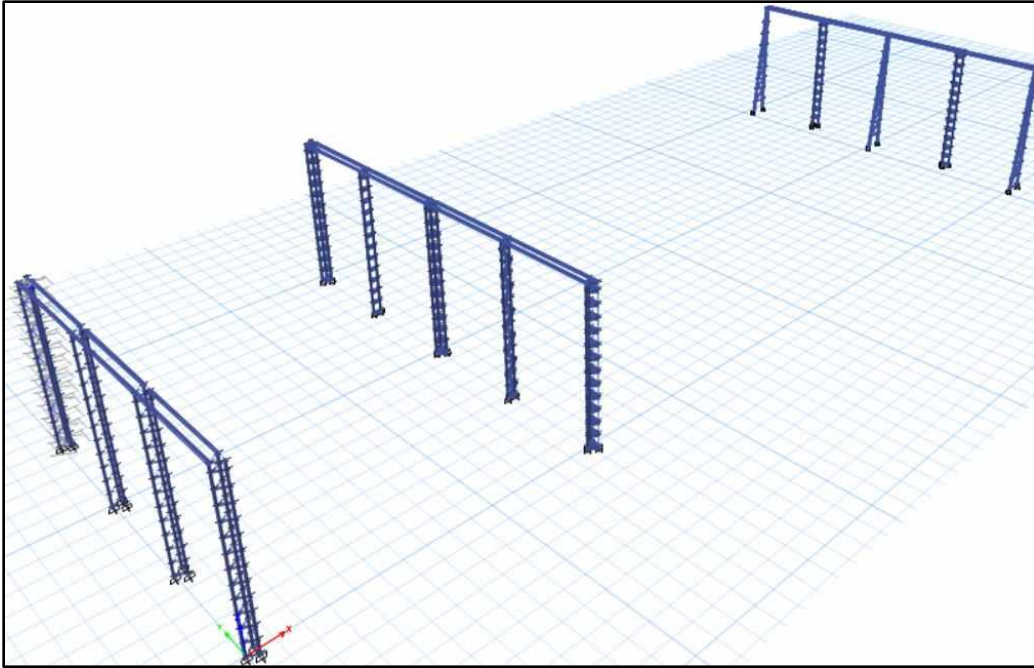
Vista en Planta – Configuración Geométrica de la Estructura Metálica.
